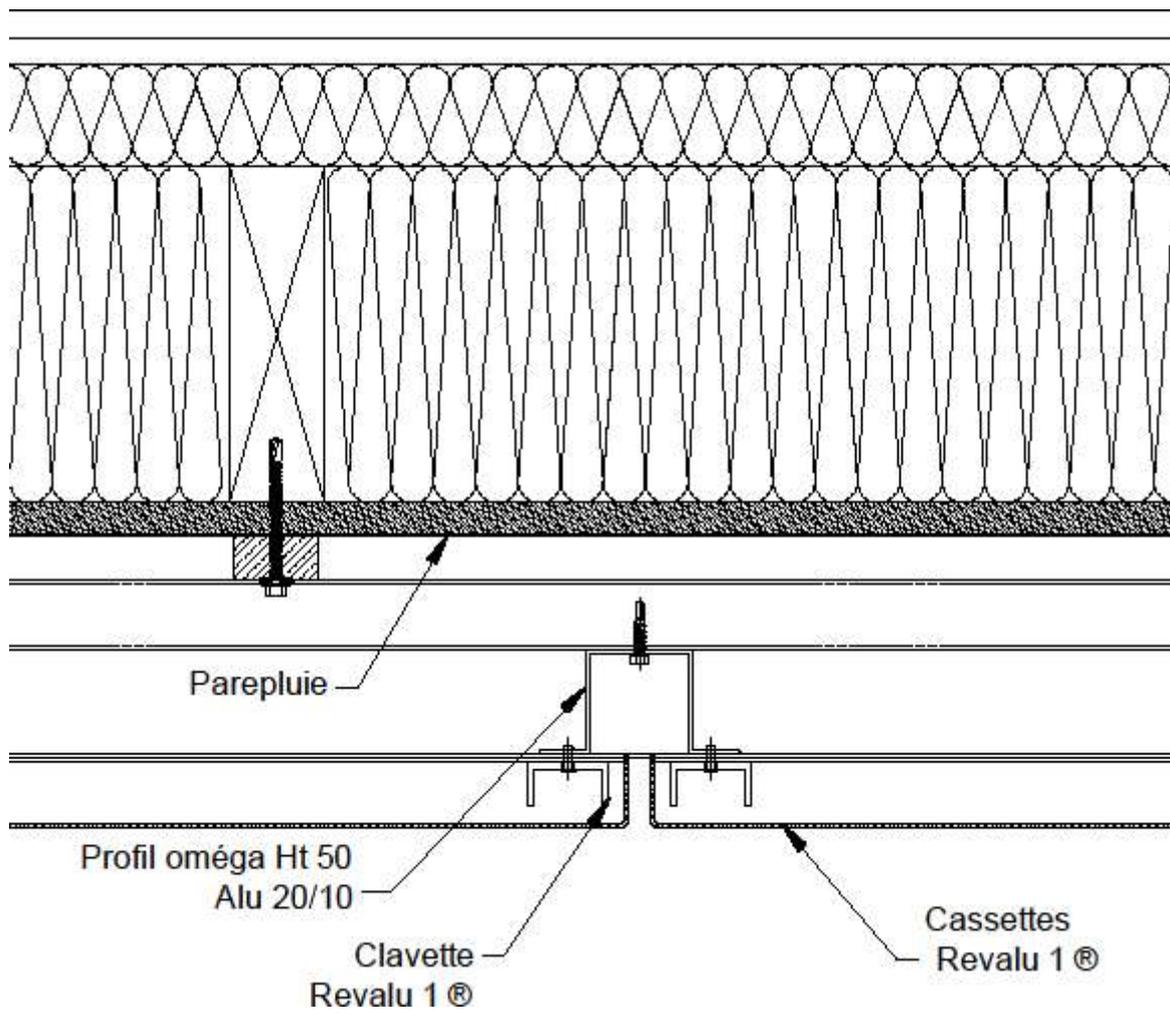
Coupe horizontale sur joint vertical (support MOB)
